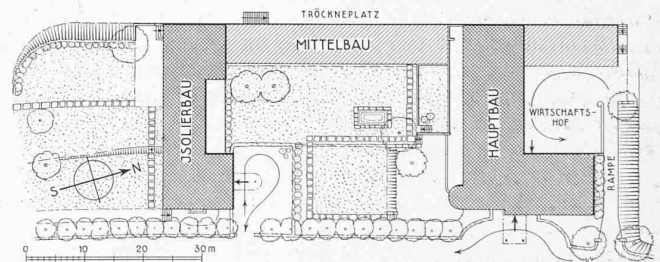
Lageplan (am untern Rand die Zufahrtstrasse). — Masstab 1 : 1200.
